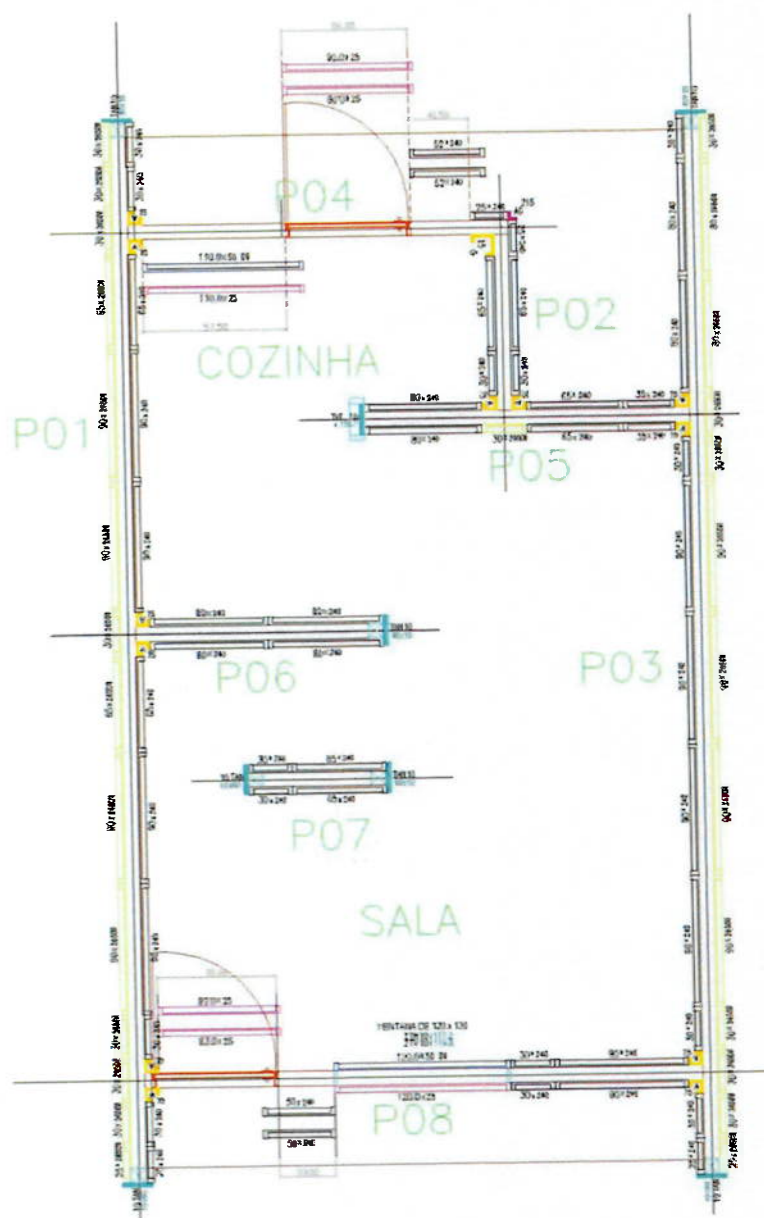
Estudo para utilização das fôrmas da obra Valle Verde Cotia – Planta do Pav. Inferior Jd. Girassol II
